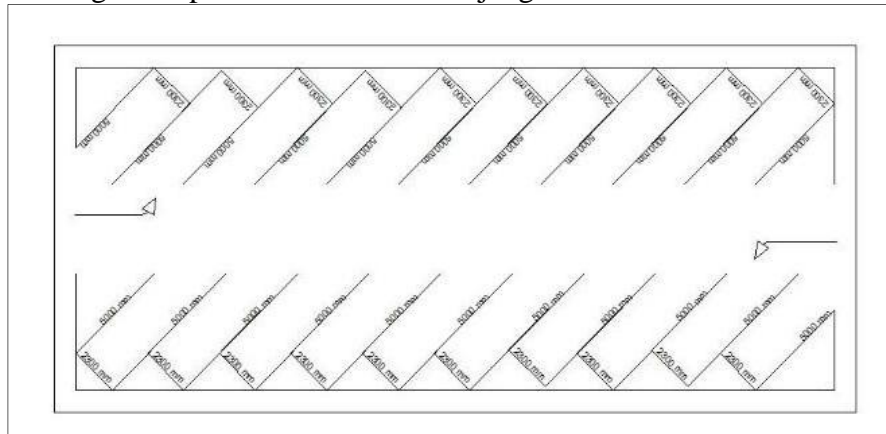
Desain Lahan Parkir Off Street Parking.
